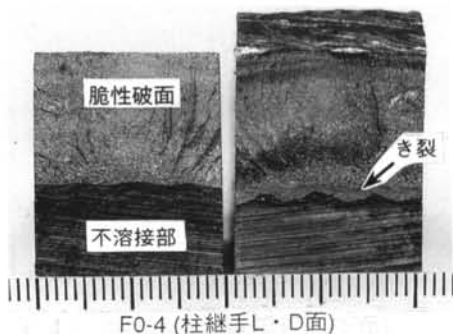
加力後の柱部分溶込み溶接継手のき裂状況 (F0-4)
